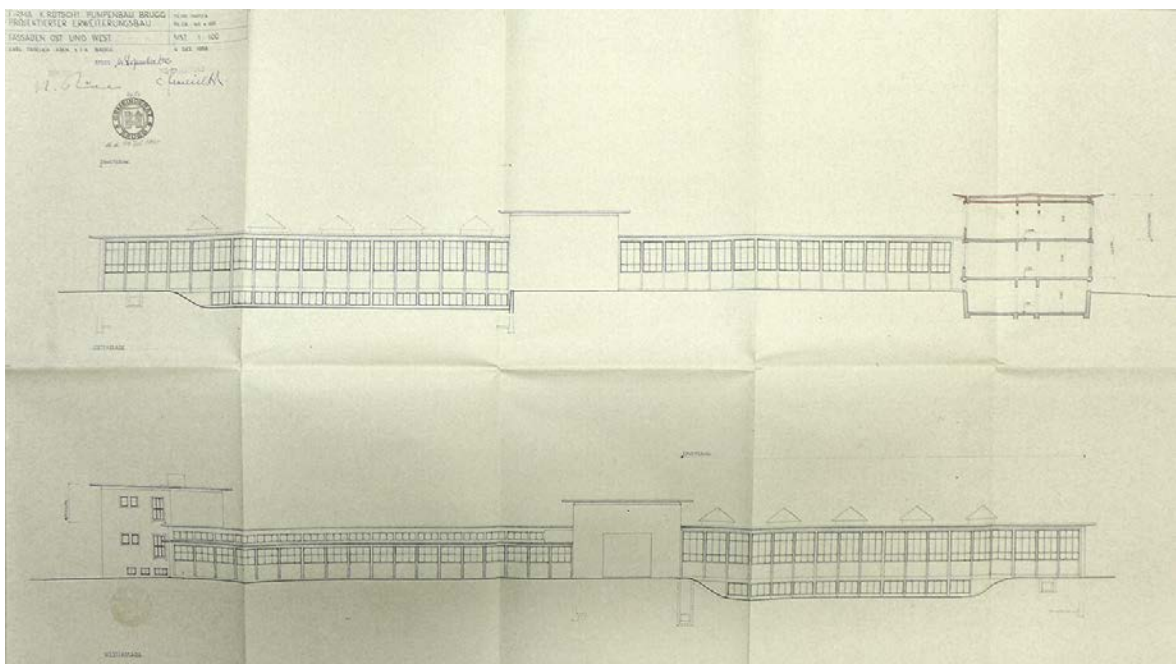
Baueingabeplan Erweiterung Werkhalle und Aufstockung Bürogebäude 1957. (Baugesuchsarchiv Dossier 2653)
